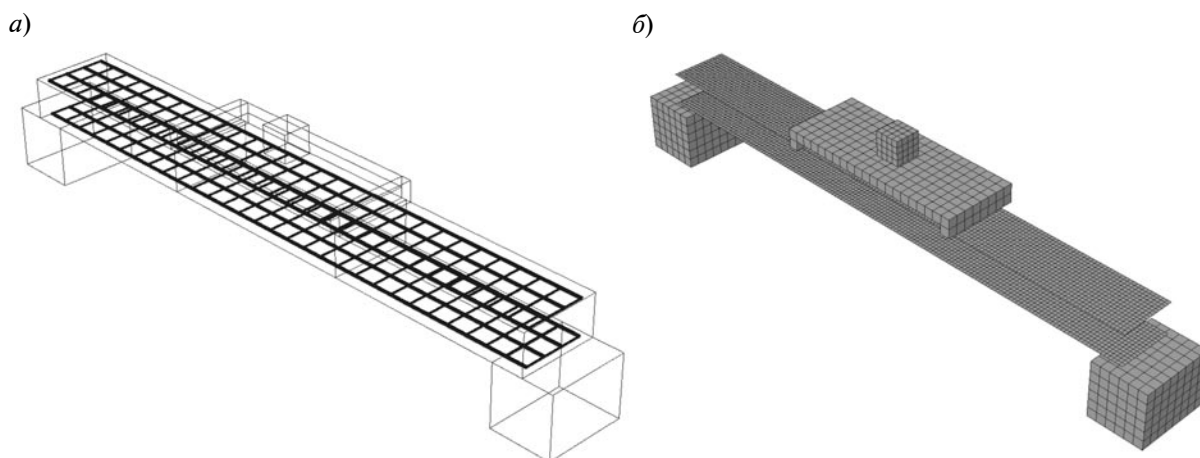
Модели железобетонной плиты со встроенным (а) и с распределенным (б) армированием (бетонная часть не показана)
